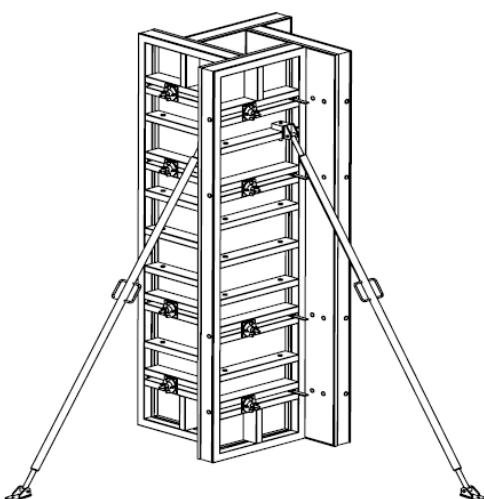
Опалубка колонн на универсальных щитах
